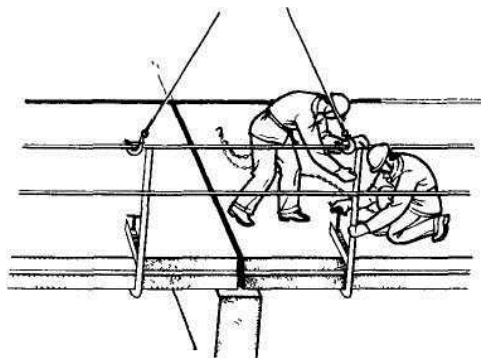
Укладка и анкеровка плиты перекрытия.
